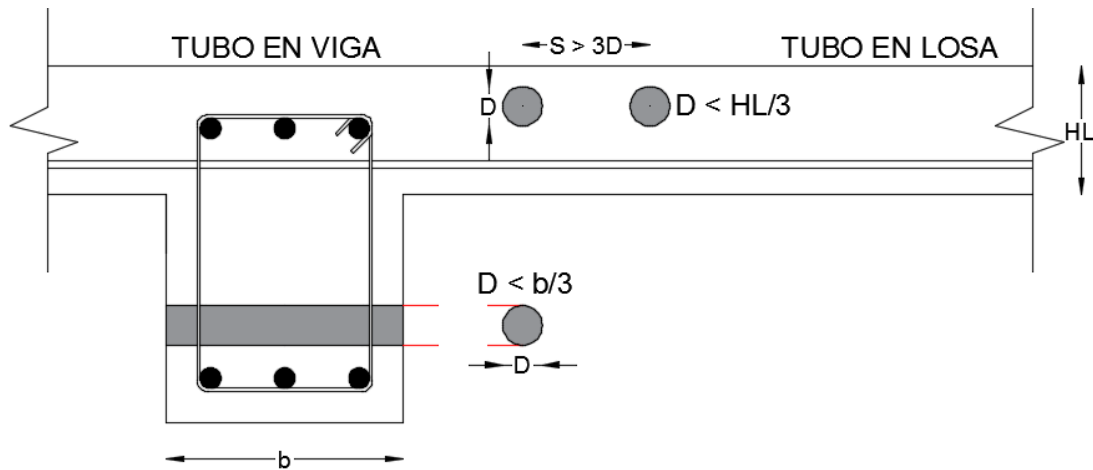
Disposiciones dadas en los Requisitos de Reglamento para concreto estructural ACI 318-08 para embeber tuberías y ductos en vigas o losas de concreto reforzado
